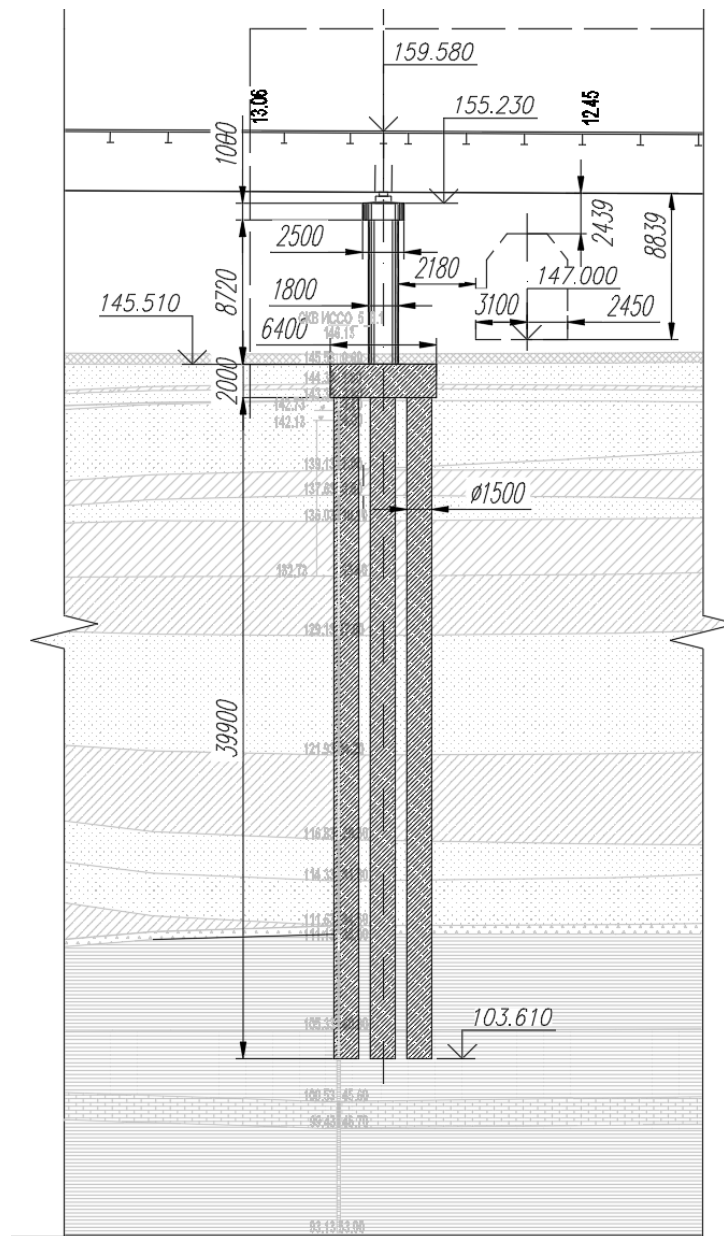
Фрагмент посадки опоры на инженерно-геологический разрез [85]
